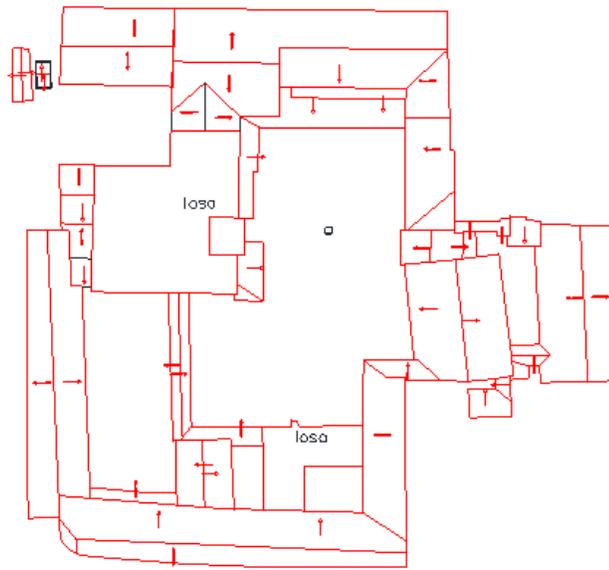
Levantamiento topográfico - planta de cubiertas
